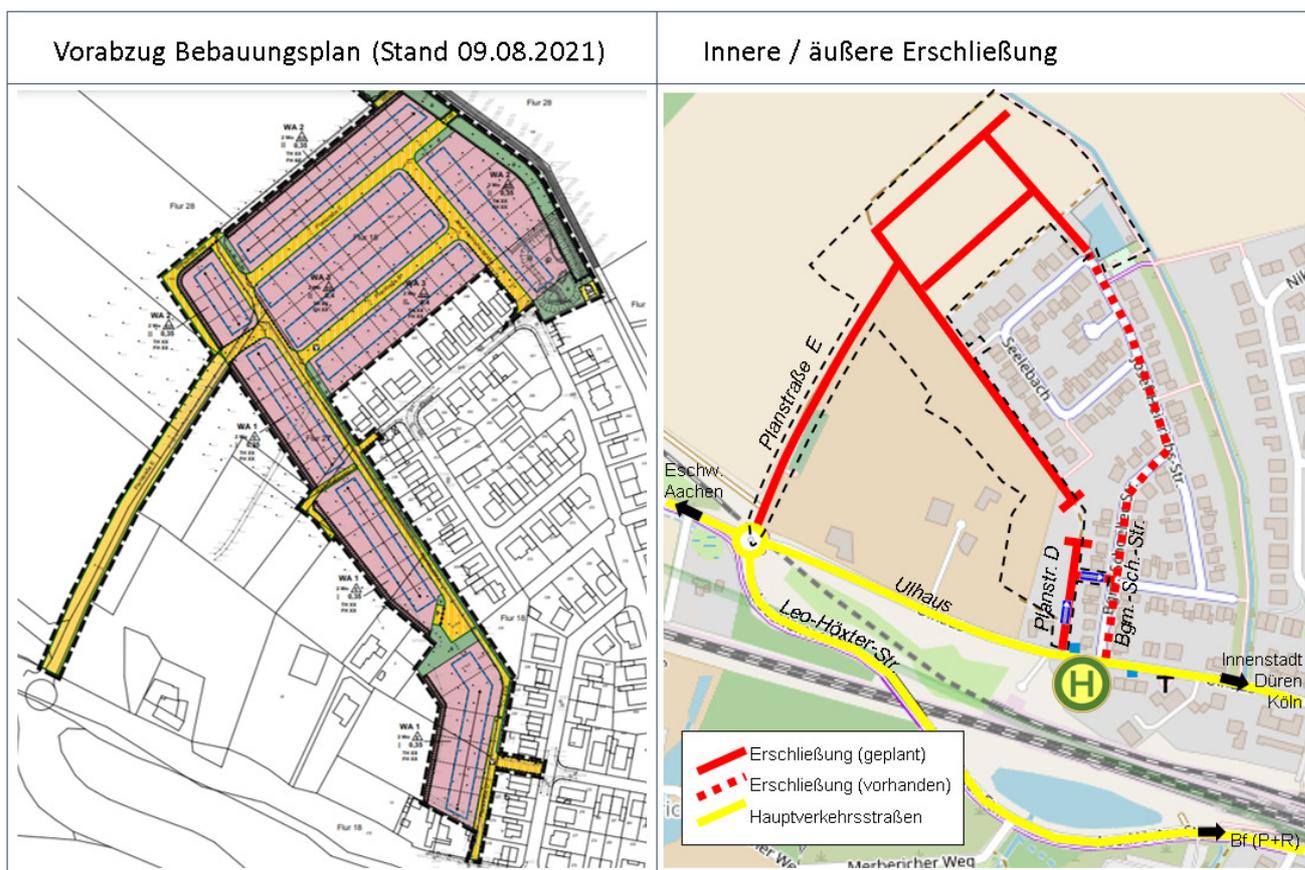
Bebauungsplan (Stand 09.08.2021) und Erschließungsstruktur für das geplante Baugebiet
